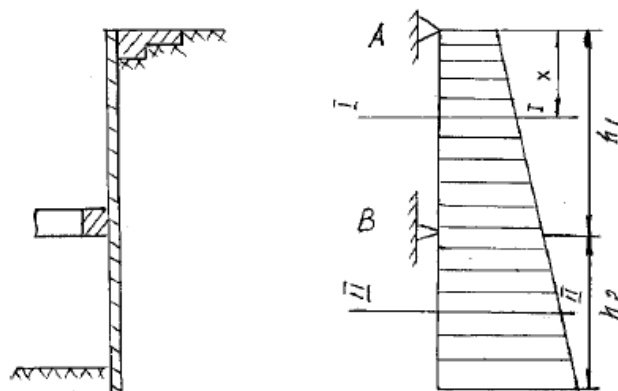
Расчетная схема тонкой заанкеренной неразрезной стены с двумя опорами
